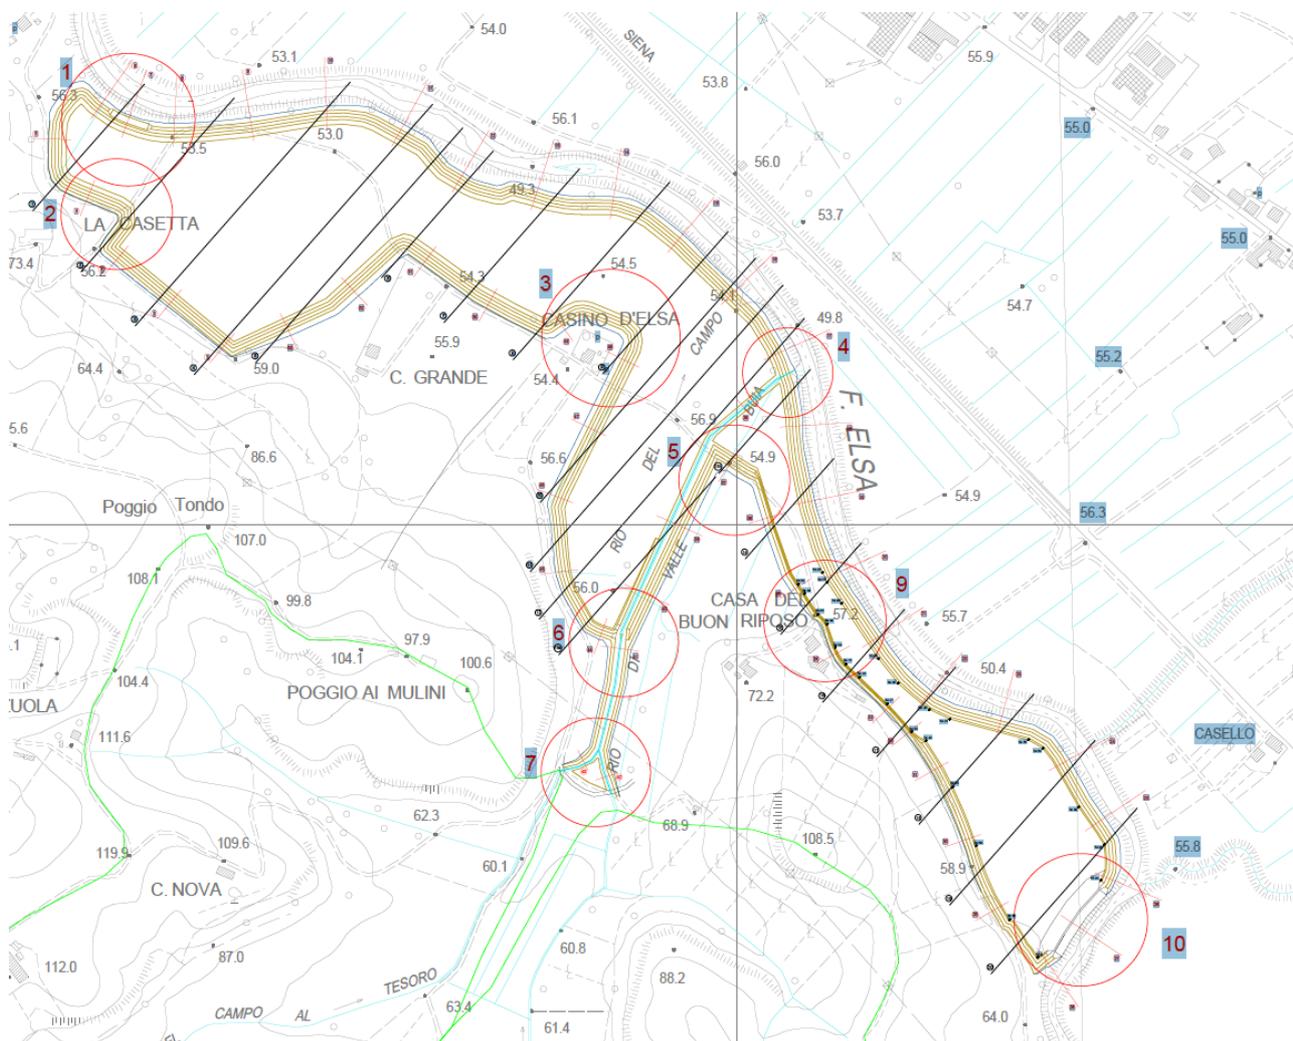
Planimetria degli argini della cassa di espansione Sud.
